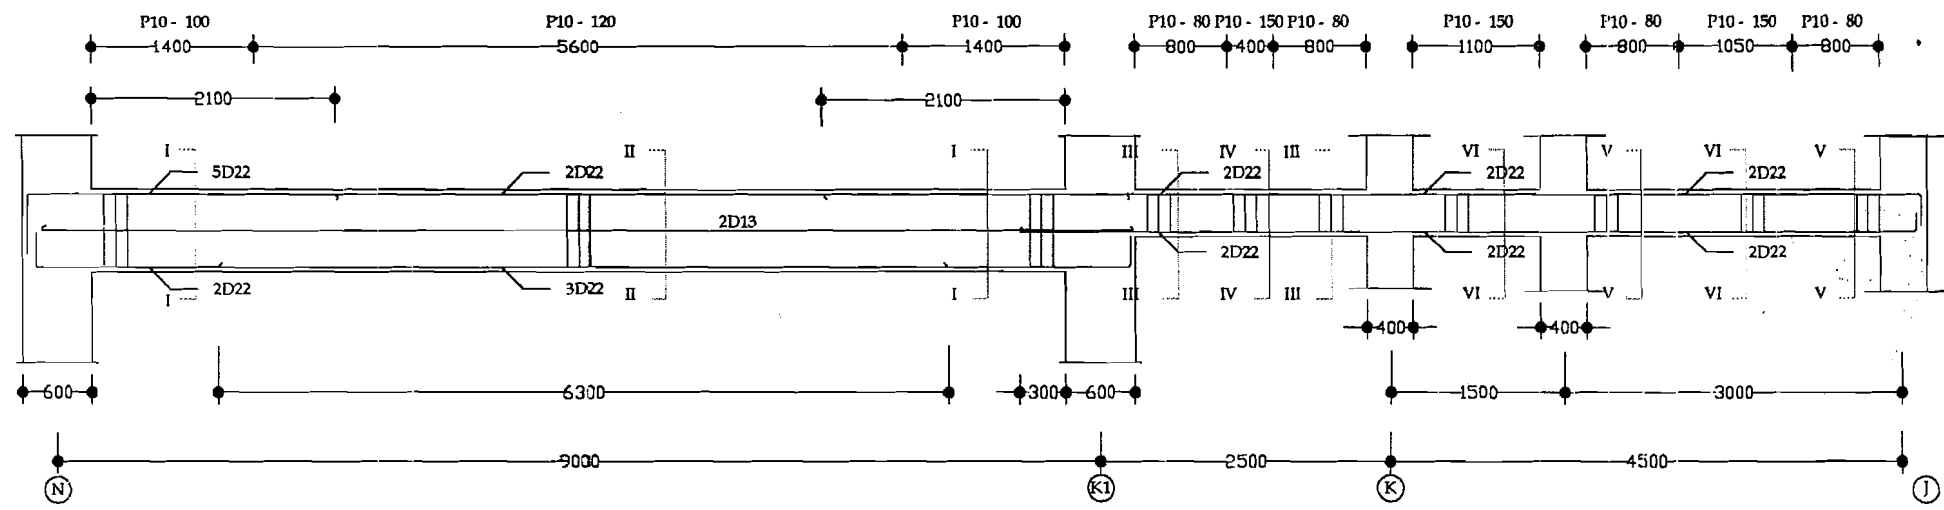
Detail Tulangan Balok Induk BA3 As K Lt 2
